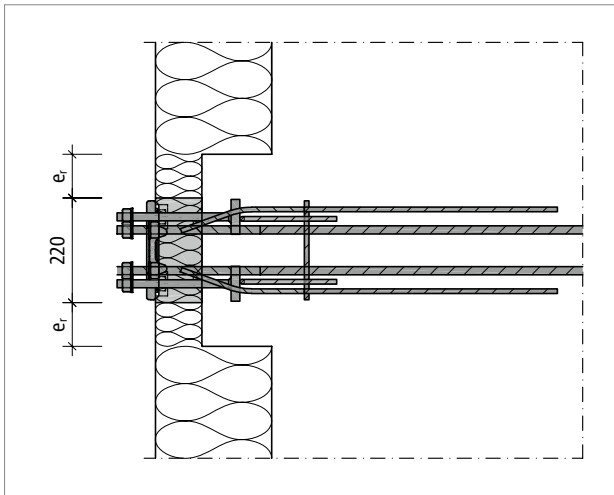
Schöck Isokorb® XT type SK : Distances aux bords
